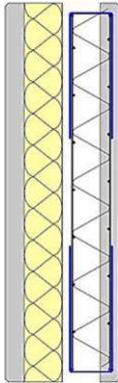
Poteau excentré coulé en place au droit 'un joint vertical
